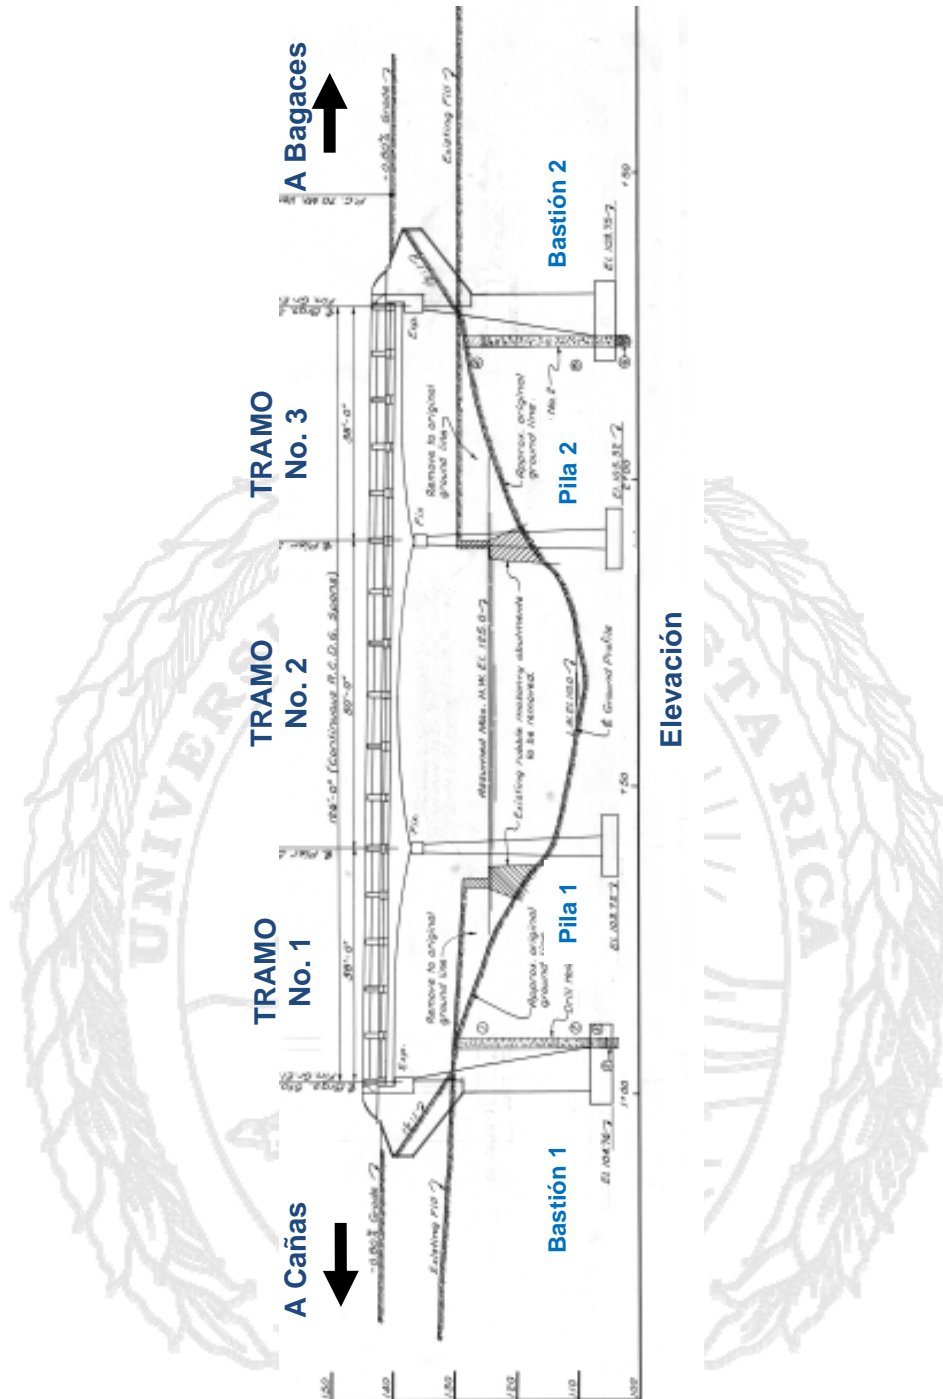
Vista en elevación en planos estructurales y nomenclatura utilizada para la identificación de los distintos componentes del puente sobre el río Montenegro.
